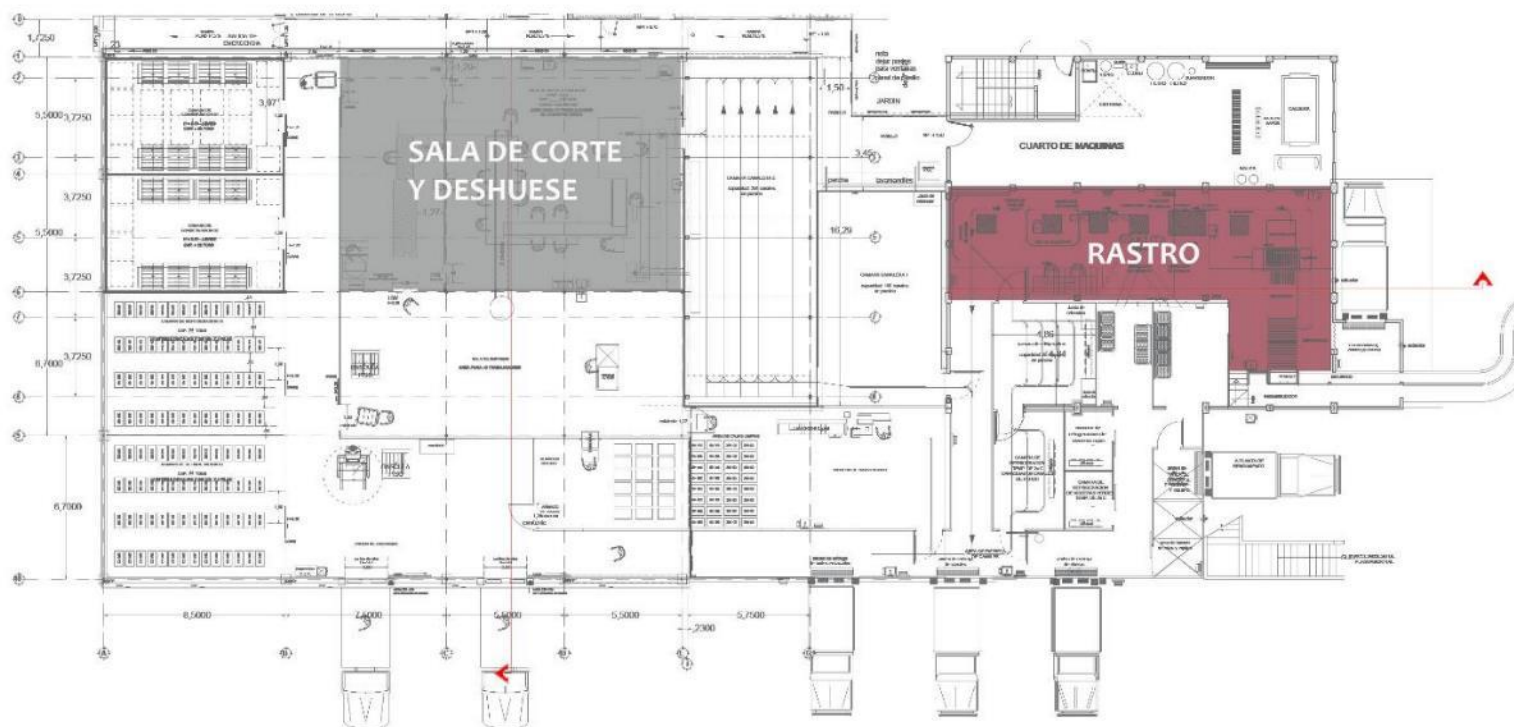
Planta arquitectónica con áreas de monitoreo delimitadas. Elaboración propia.
